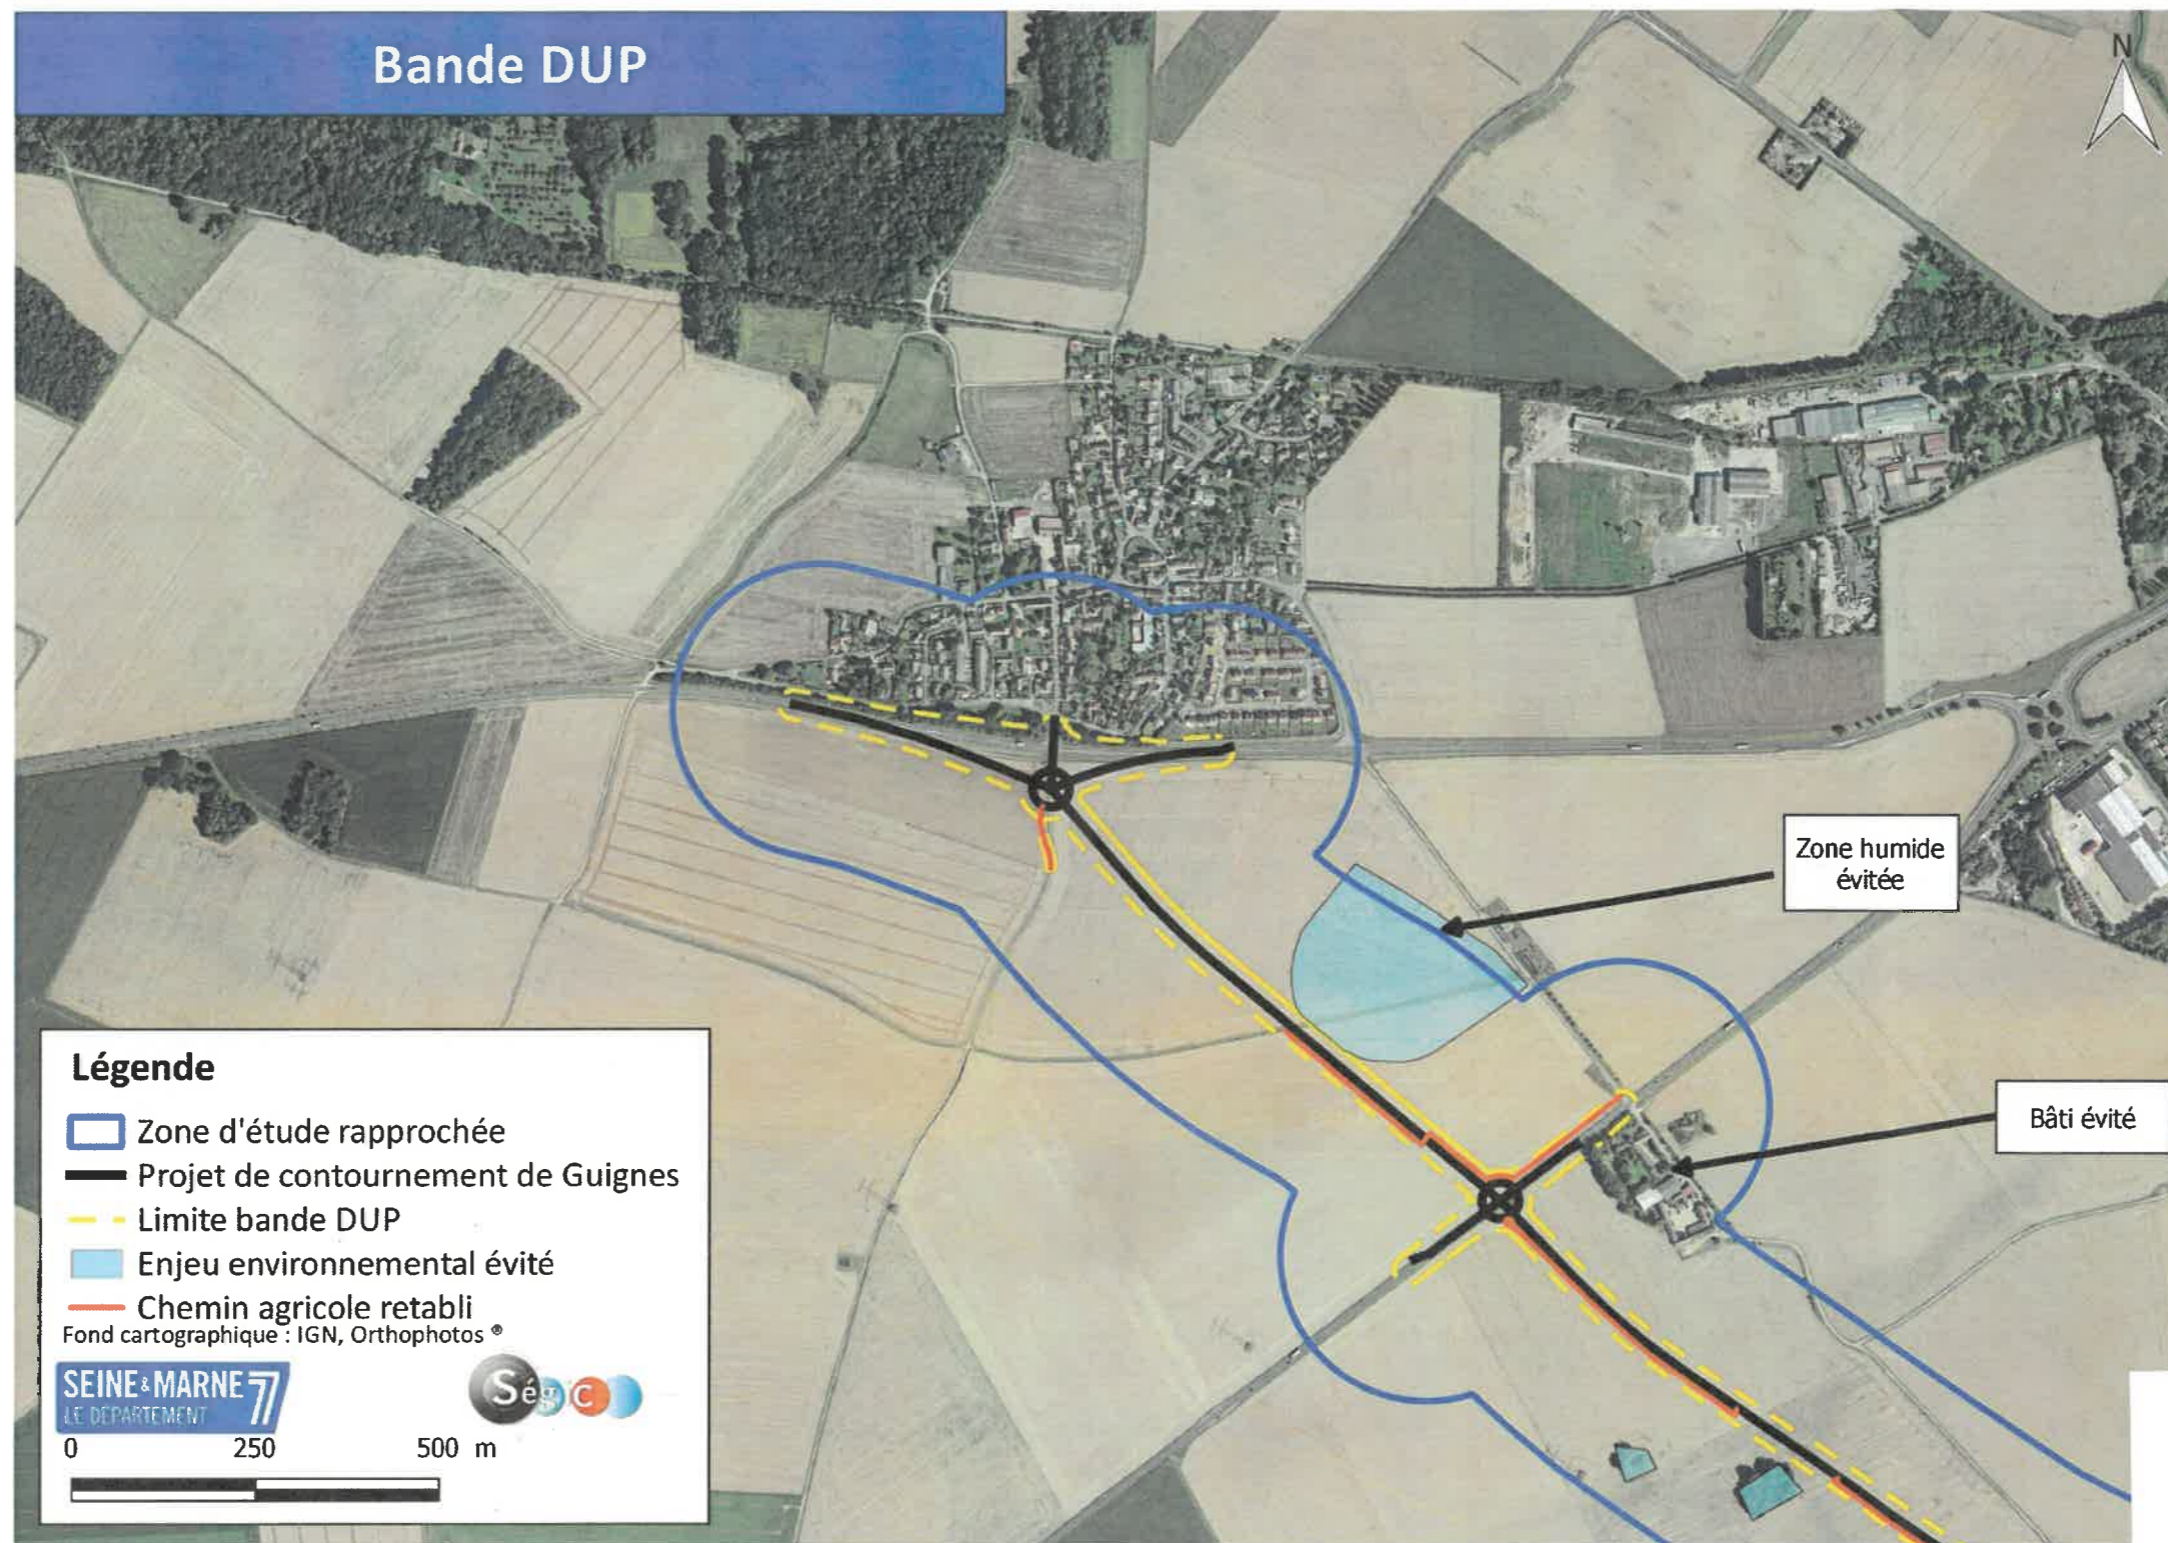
Bande DUP retenue – Planche 1/4 (Source : SEGIC Ingénierie)
